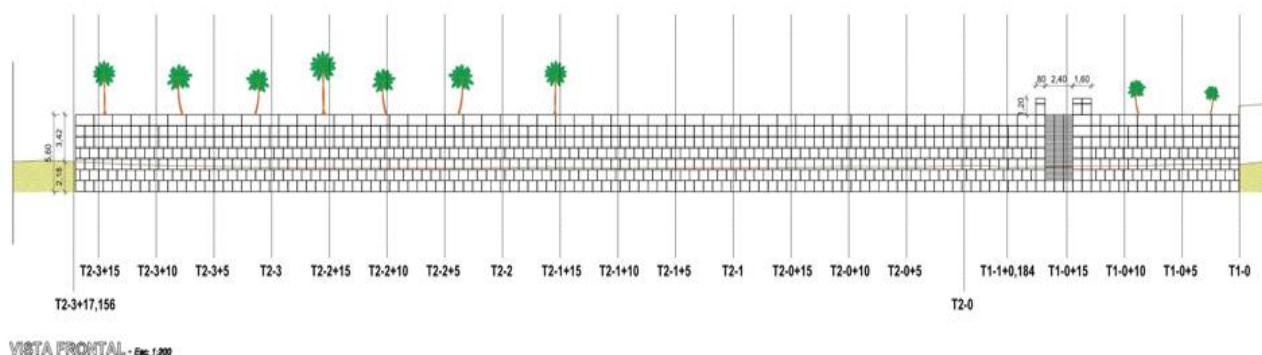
Vista frontal – projeto executivo contenção marítima em BetonBloc, Ipojuca/PE.
